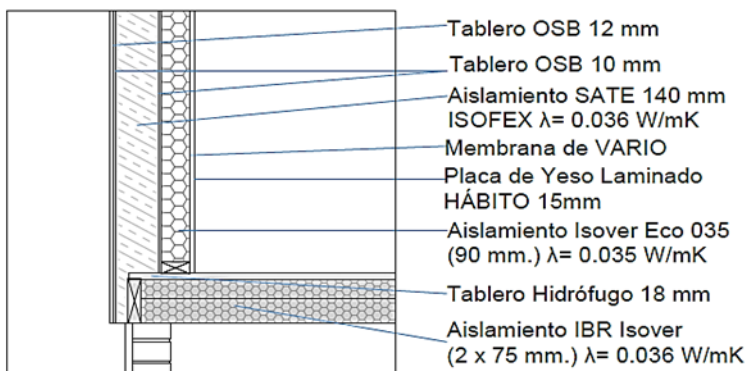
(b): Encuentro fachada – solera vivienda ABS.
